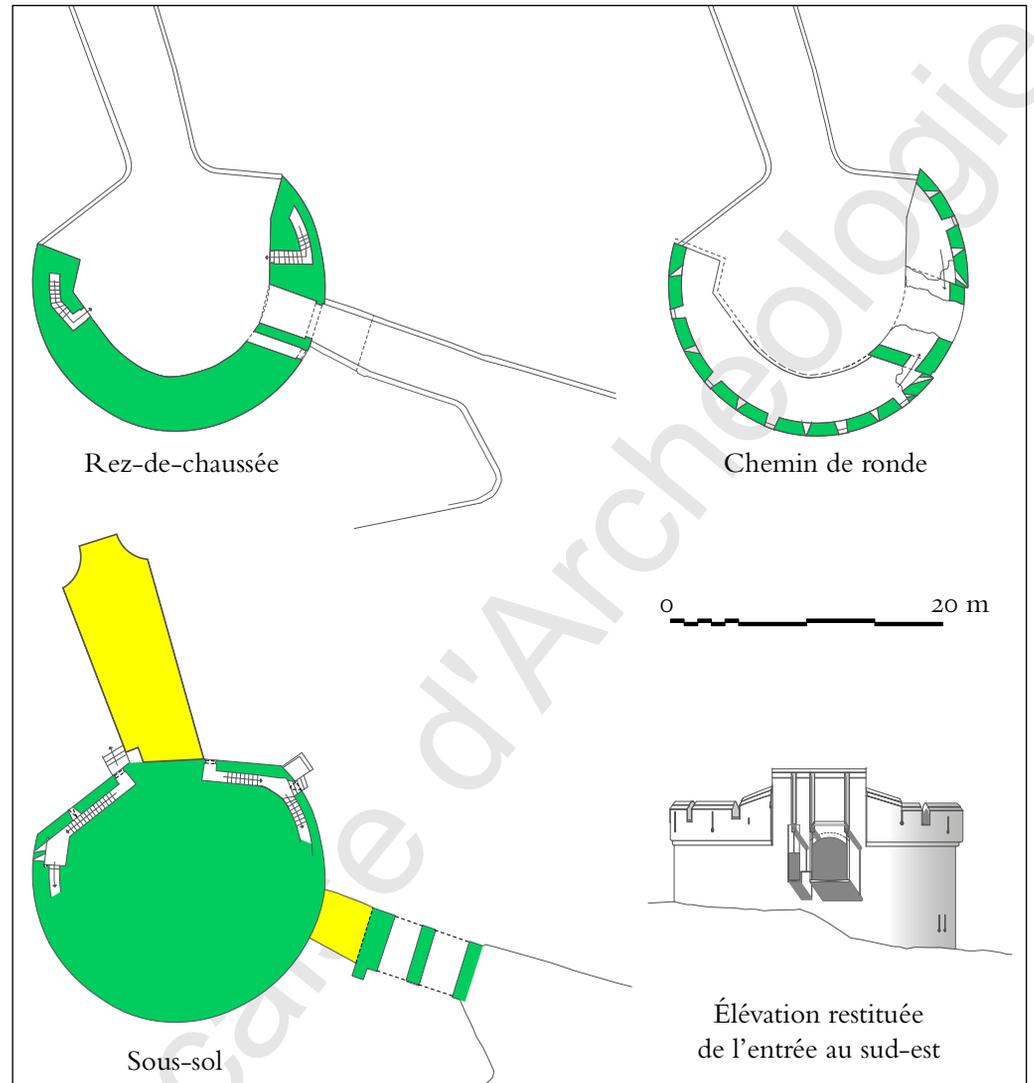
Montreuil-Bellay, château, plans et élévation du boulevard (dessin J. Mesqui 2022).
